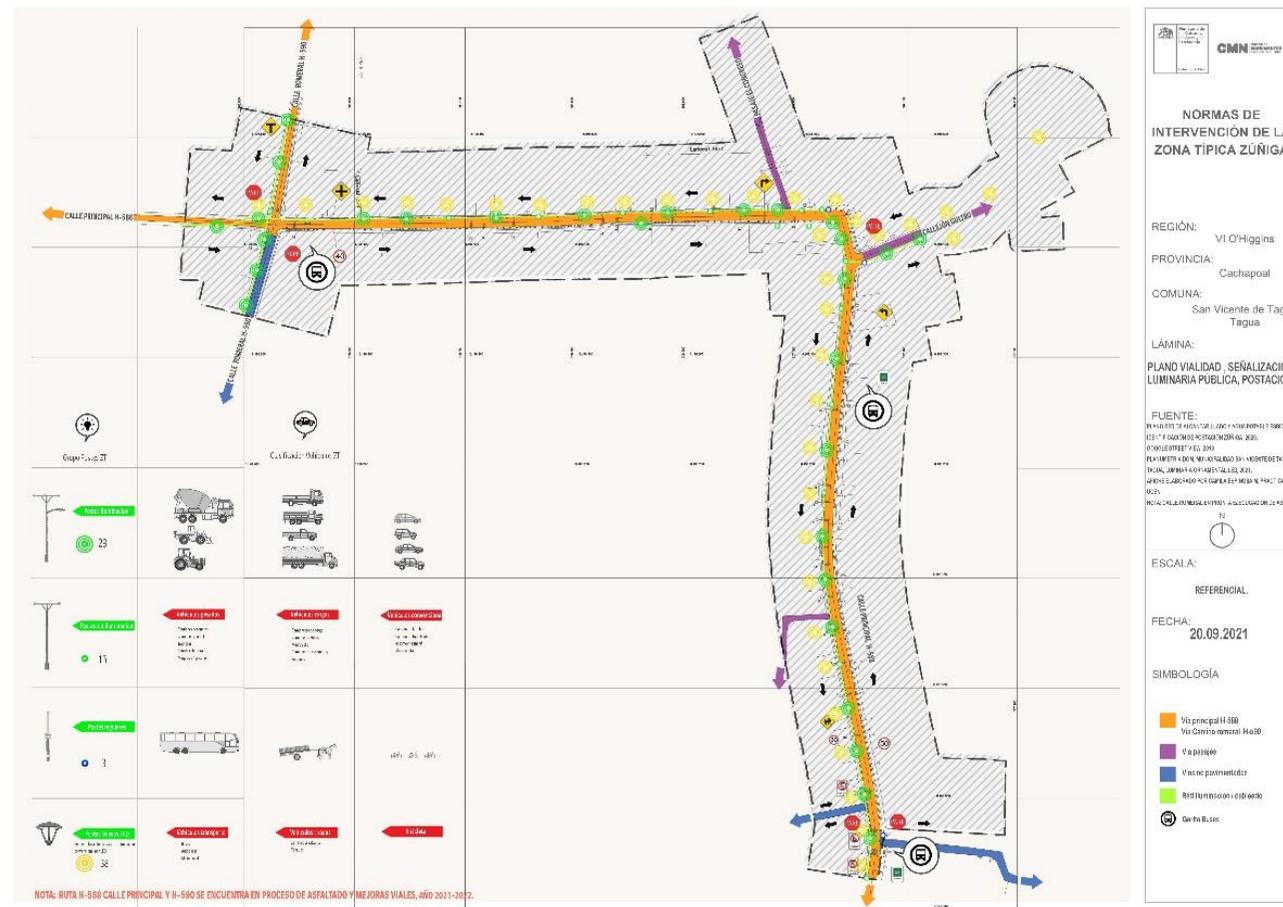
Planimetría vialidad, señalización, iluminación y postación ZT Zúñiga. OTR OH CMN, 2024.
